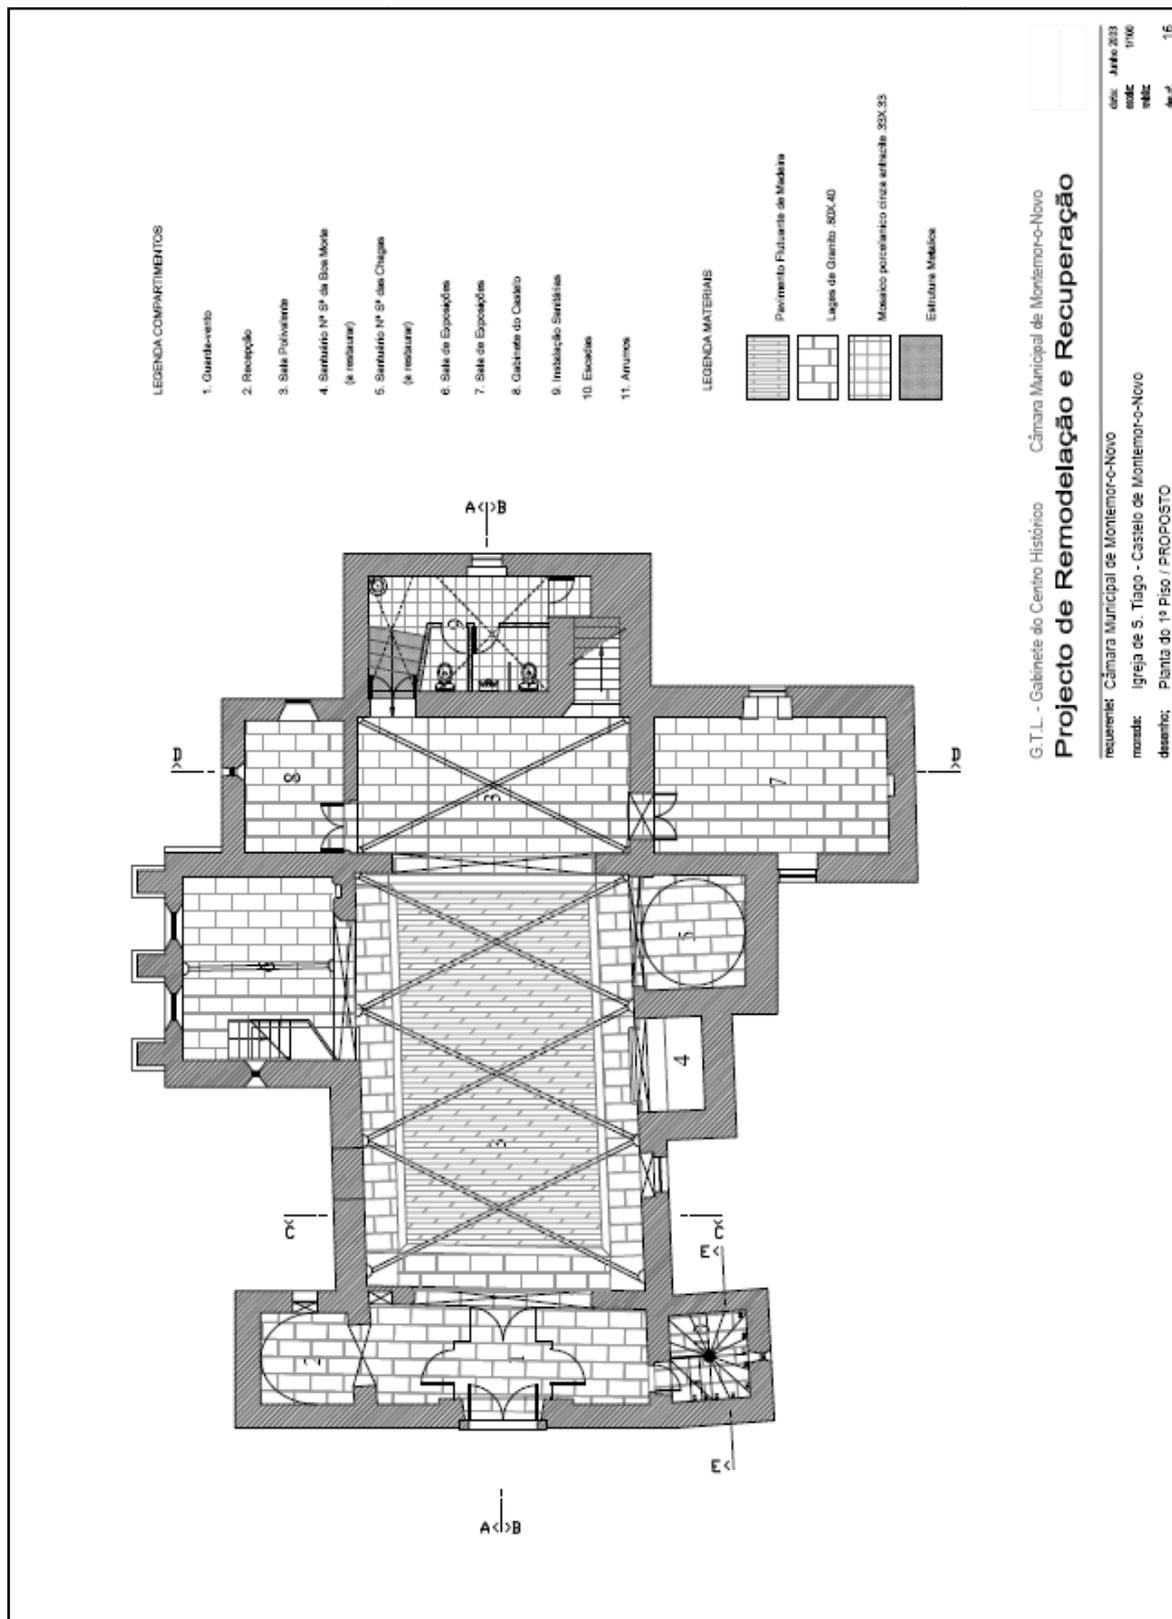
Planta da Igreja de São Tiago, 1º piso
